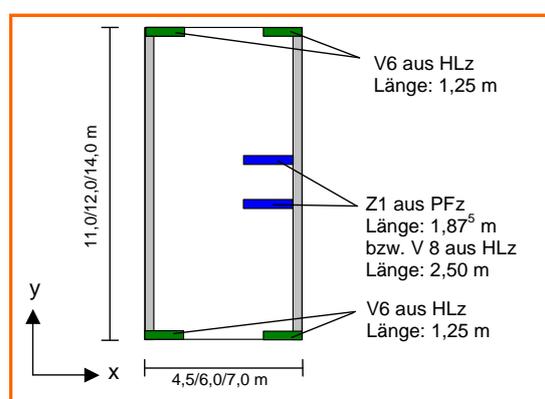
Schematischer EG-Grundriss des in [4] untersuchten Reihenhauses
